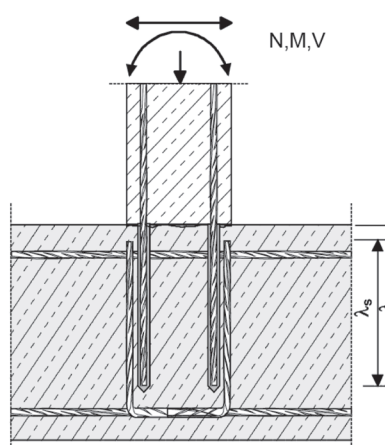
Unión superpuesta a una fundación de una columna o un muro donde las armaduras están sometidas a tracción.
